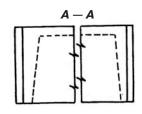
Фундаментные блоки (разрез A — A для пустотных блоков)
